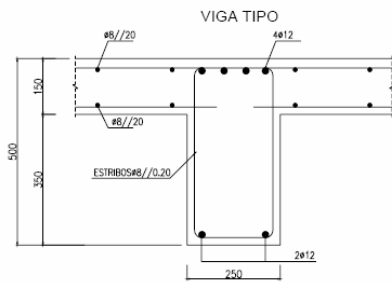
Secção e pormenorização de uma viga tipo [mm] [Massena, 2004].
